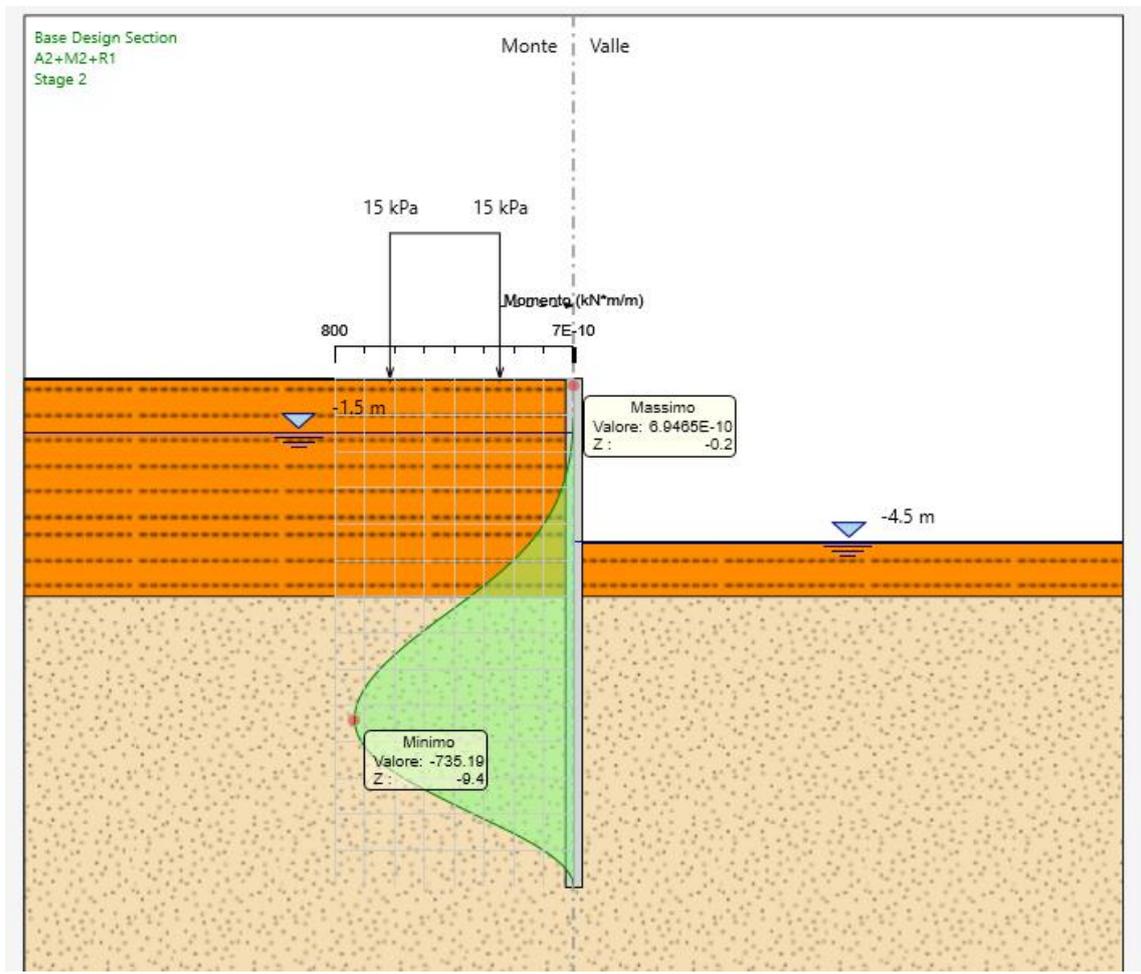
Momento di design sugli elementi strutturali – Verifica SLU (A2+M2+R1) – kN\*m/m
